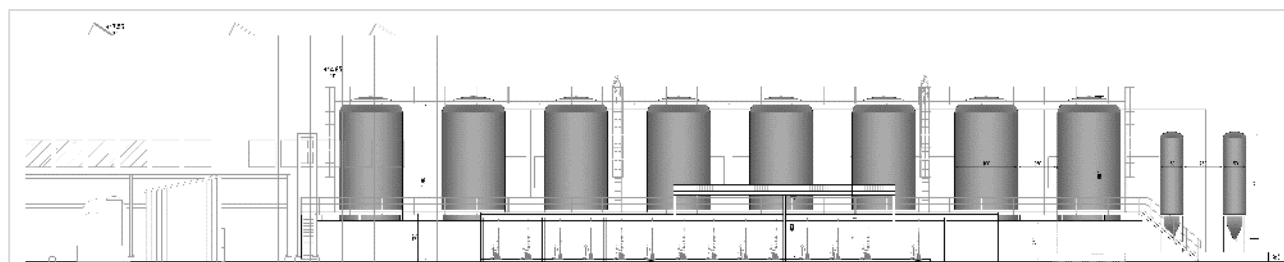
Vista in sezione dei serbatoi di stoccaggio sezione N9 della piattaforma polifunzionale HEA (stralcio elaborato CO 05 RA VA 00 D1 PL 71.00 - N9 PROSPETTI E SEZIONI)
